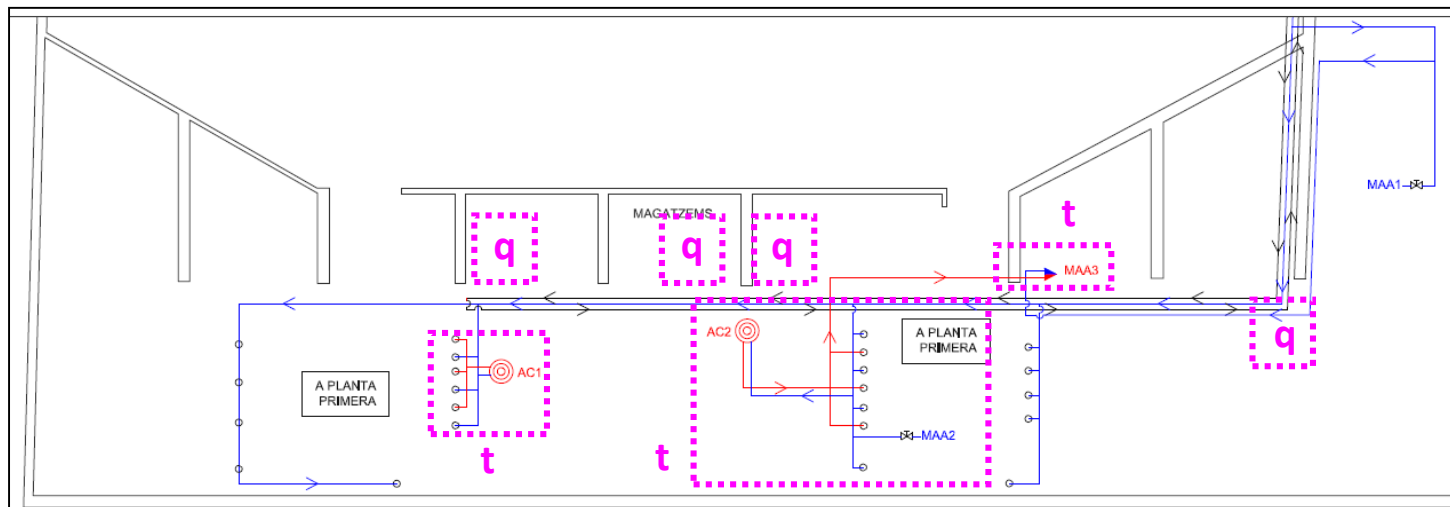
Detall traçat de canonades i magatzems planta baixa.
